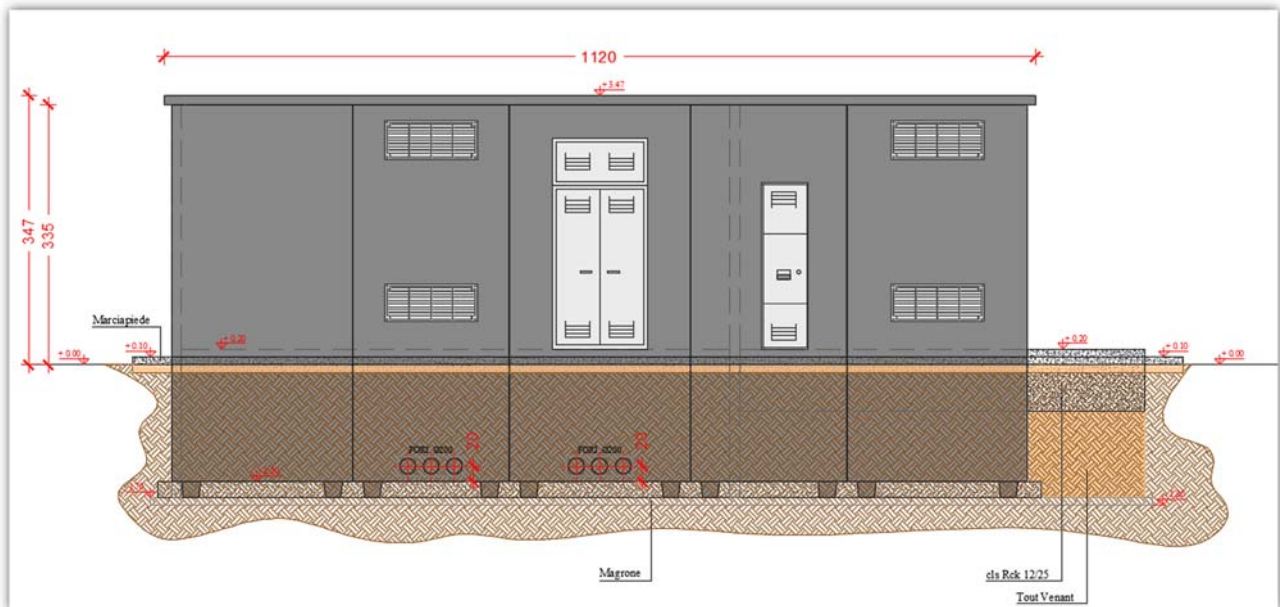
Tipico Prospetto principale della cabina Slave-Master
